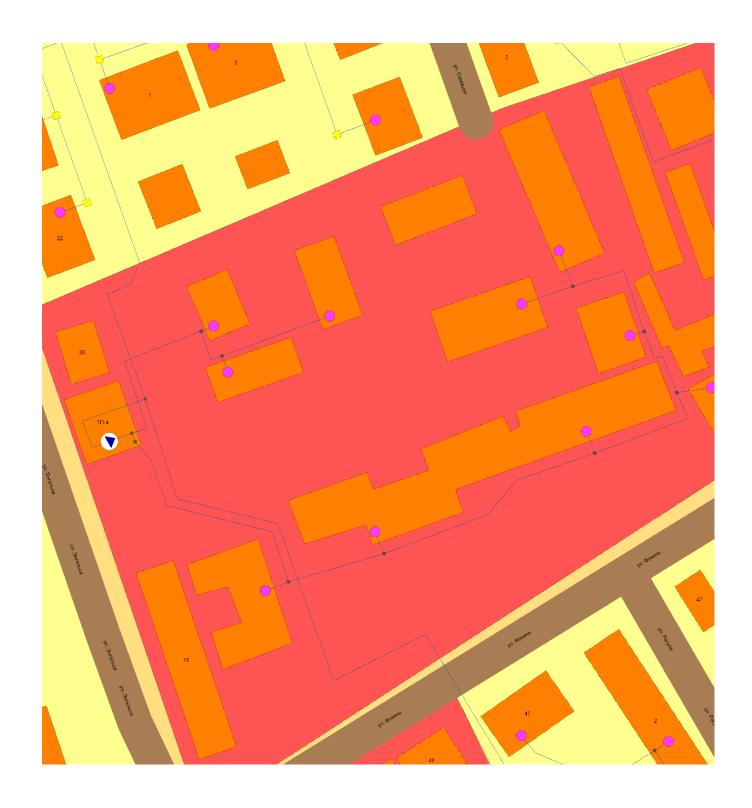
Схема тепловой сети от теплового пункта №3 по ул. Фокина от котельной ОАО ЛТЗ
